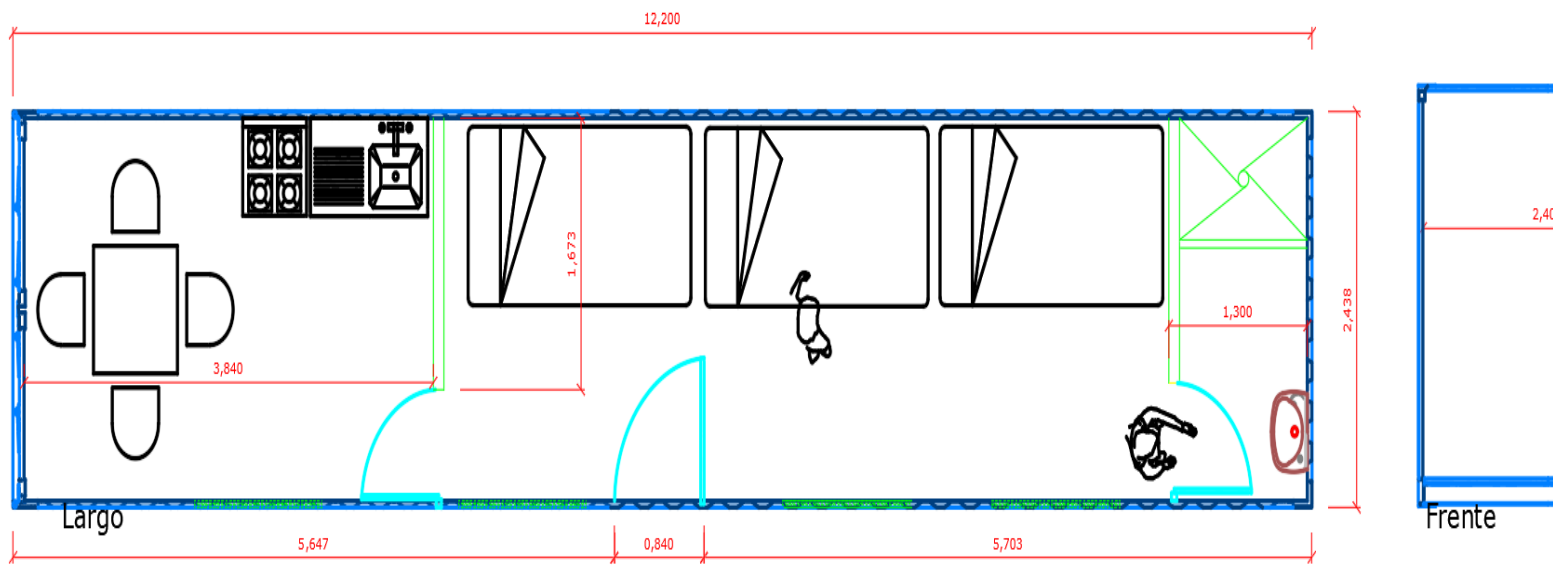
Planta arquitectónica de modulo con contenedor N° 1 de 20 pies.
